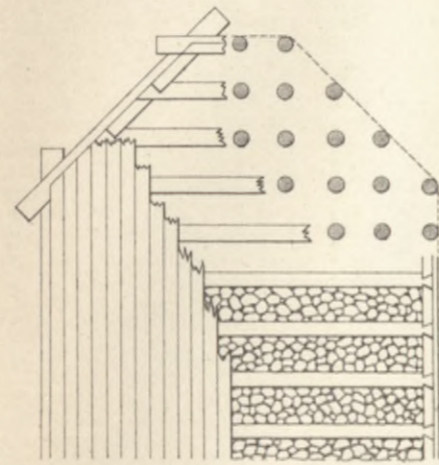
u. 19. Rost für ein schiefes Widerlager. Abb. 18. Querschnitt.
